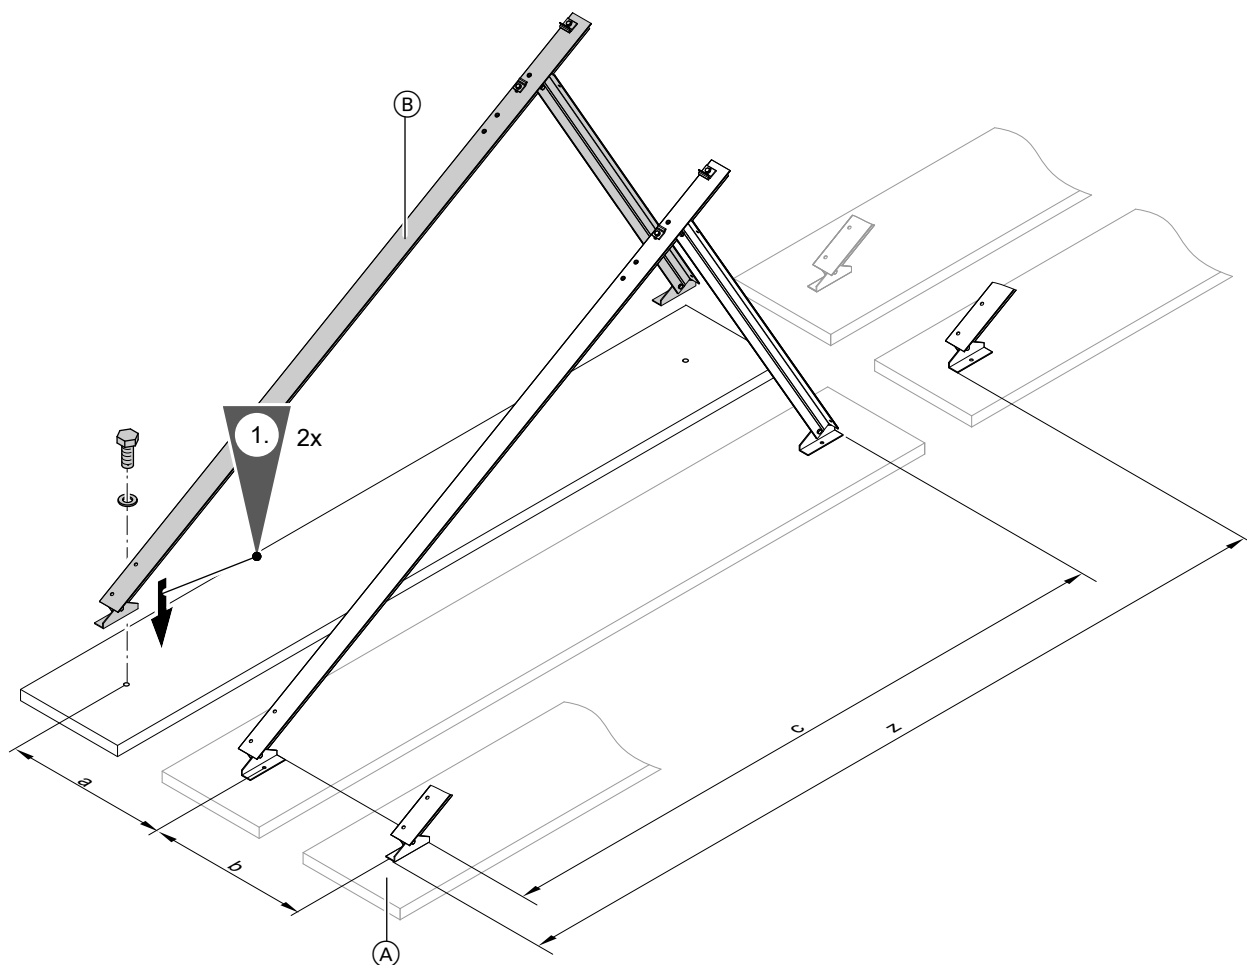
BefestigungsfüÙe als Bohrschablone benutzen.
